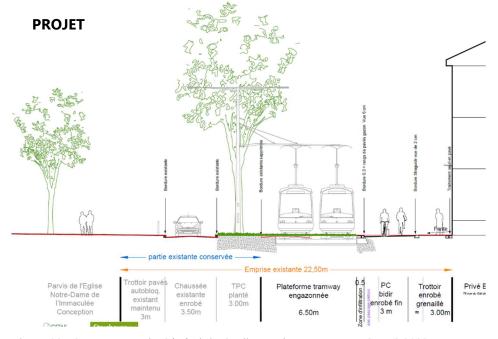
Coupe Route du Général de Gaulle Nord (source : AVP, GETAS 2023)
